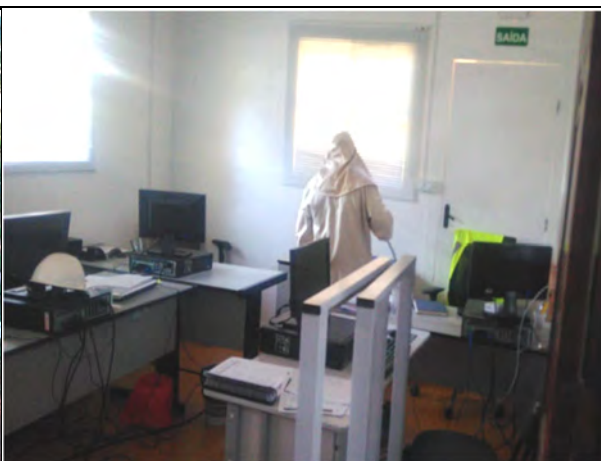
Dedetização realizada no canteiro de apoio. (Foto: 07.02.2019)
